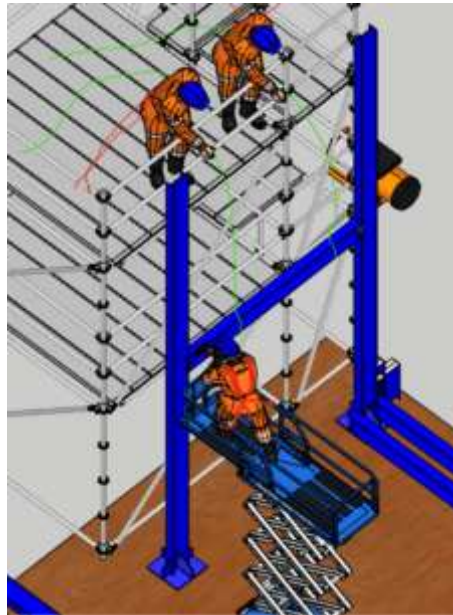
Pengamanan Kolom Depan K3 dan K4
